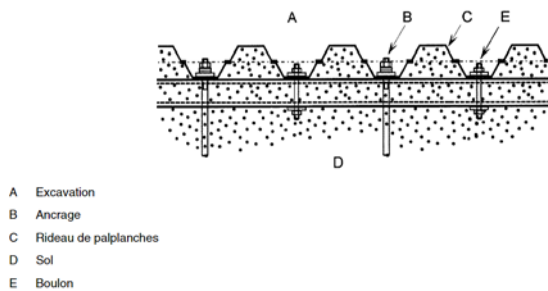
Exemple d'ancrage avec lierne à l'arrière du rideau de palplanches
